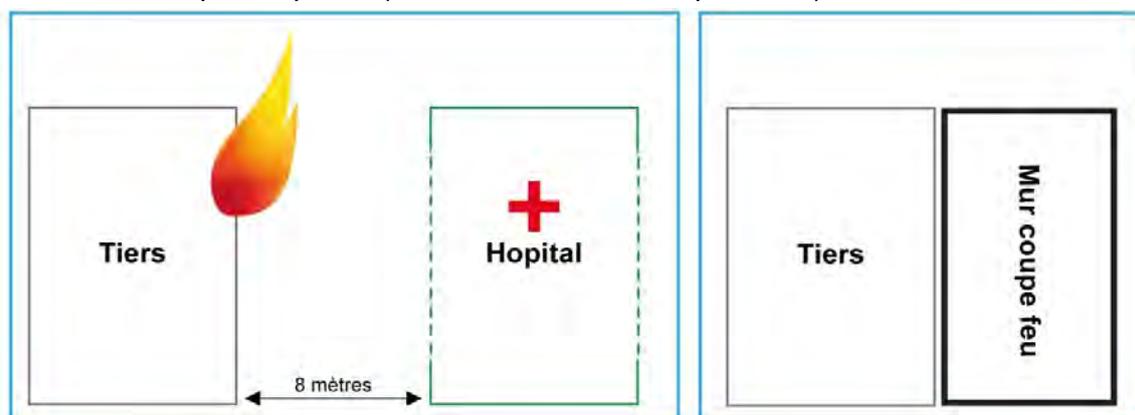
Schéma de principe de l'isolement des bâtiments. (Source ANCO/PAHO)
